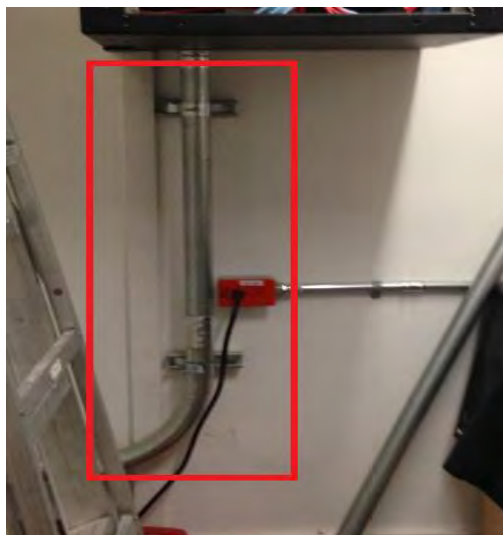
Instalación de switch, distribuidor y equipo de suministro eléctrico
